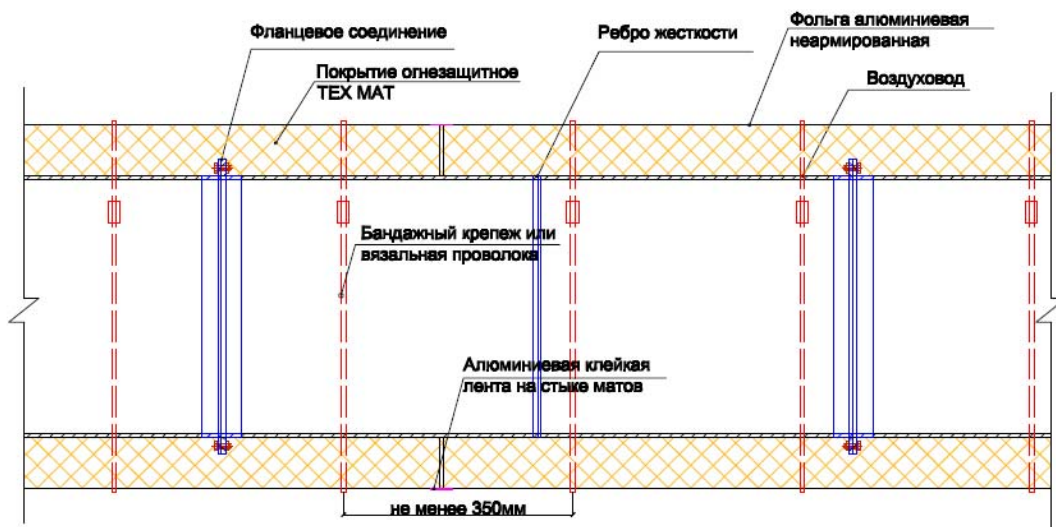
а, б. Крепление огнезащитного покрытия TEX MAT к воздуховоду с помощью бандажного крепежа или вязальной проволоки.
